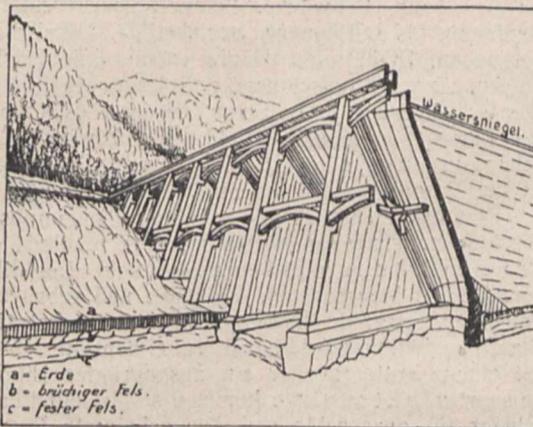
Schnitt durch die Vöhrenbacher Eisenbetontalsperre mit bloßgelegten Fundamenten.
